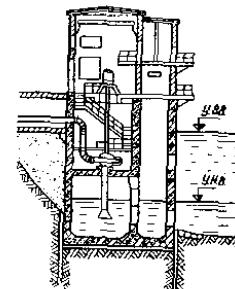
Здание насосной станции, совмещенное с береговым водозаборным и водоприемным сооружением.
